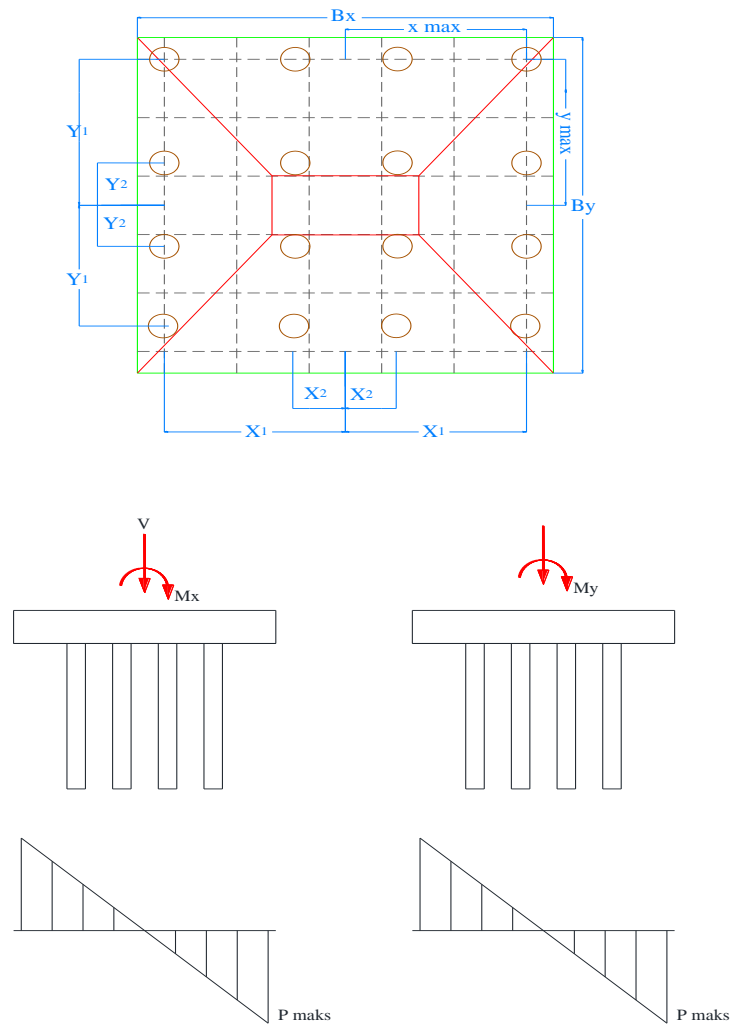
Detail Tanah pada Fondasi *Bore Pile
